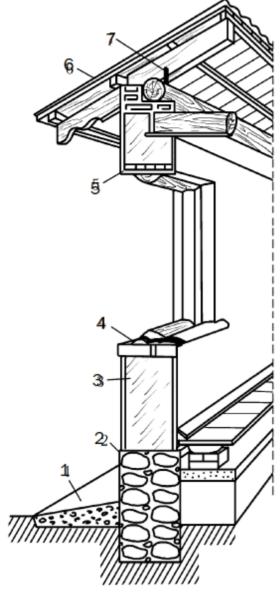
Конструкция монолитной легкобетонной стены: 1 – отмостка; 2 – слой гидроизоляции; 3 – стена; 4 – слив; 5 – перемычка; 6 – рубероид; 7 – скрутка
